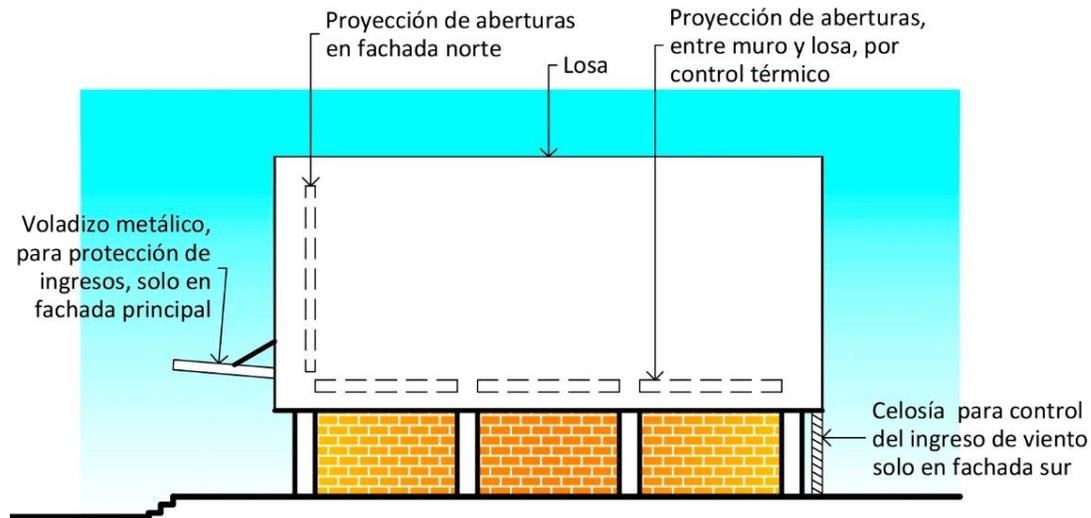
Aplicación del estilo arquitectónico. Imagen propia.
